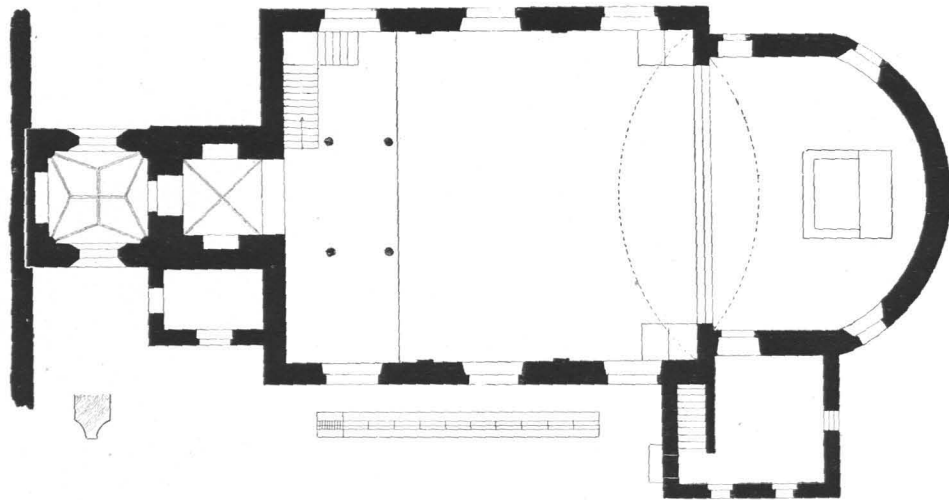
St. Gilgen, Pfarrkirche, Grundriß 1:300 (S. 14)
